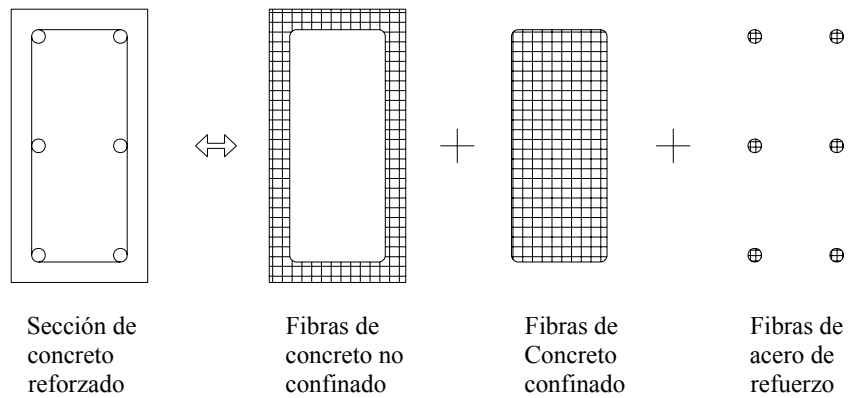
13 Modelo de análisis por fibras de secciones de concreto reforzado.
